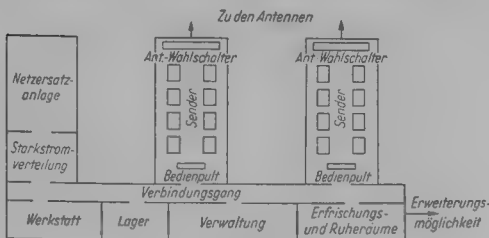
Grundriß eines Sendergebäudes mit Aufstellungsplan für die Geräte.
